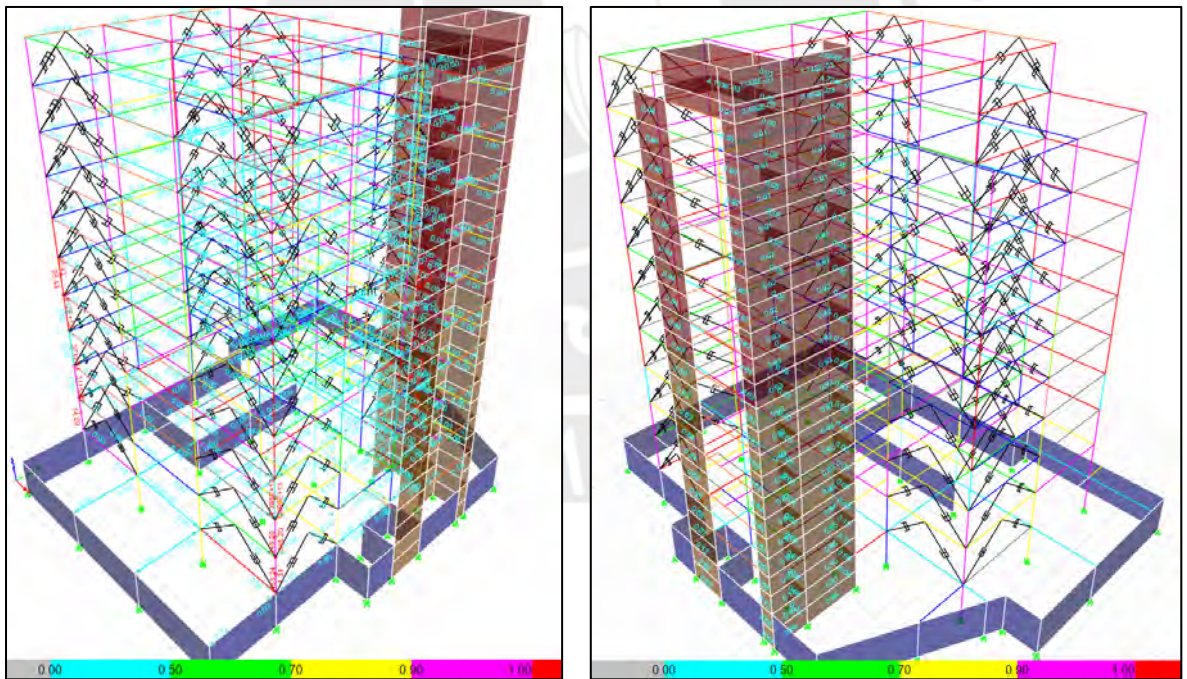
Imágenes de las vigas, columnas y placas para Prevención de Colapso
